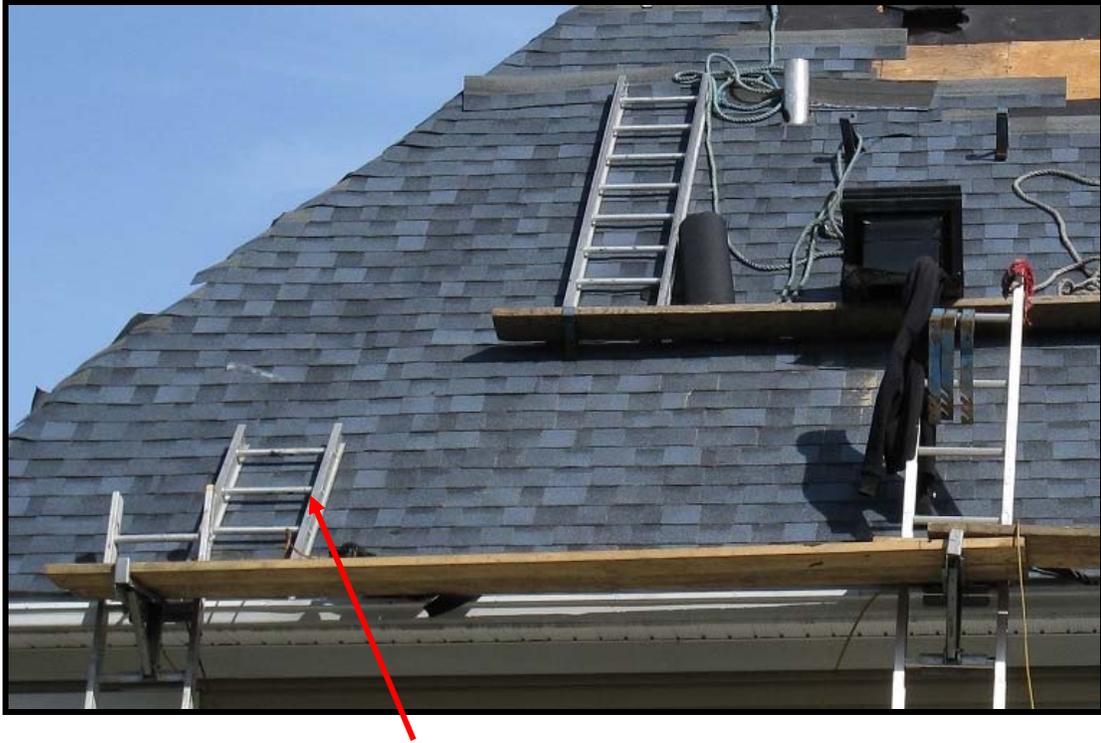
Échelle de toit en appui dans la gouttière (source : CSST)
